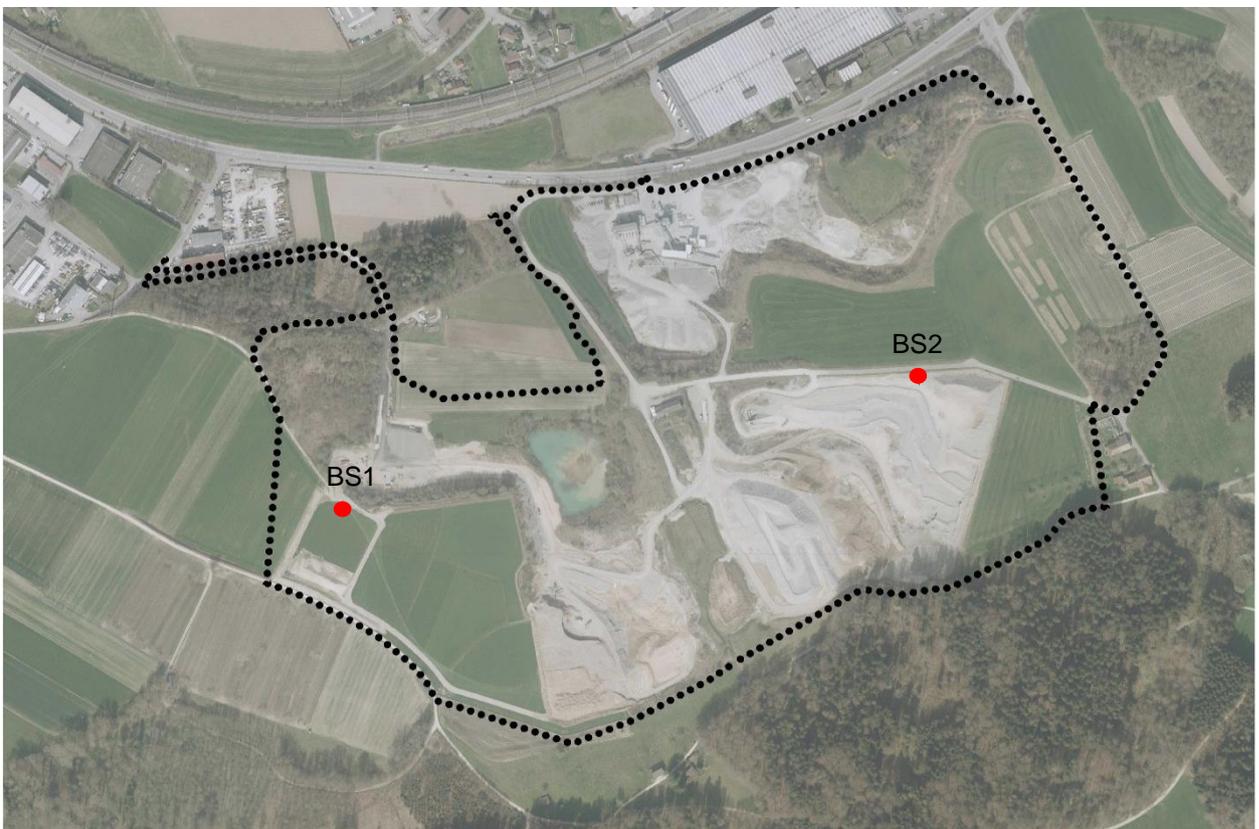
Übersicht des Projektperimeters mit Lage der Baggersondierungen BS1 und BS2
